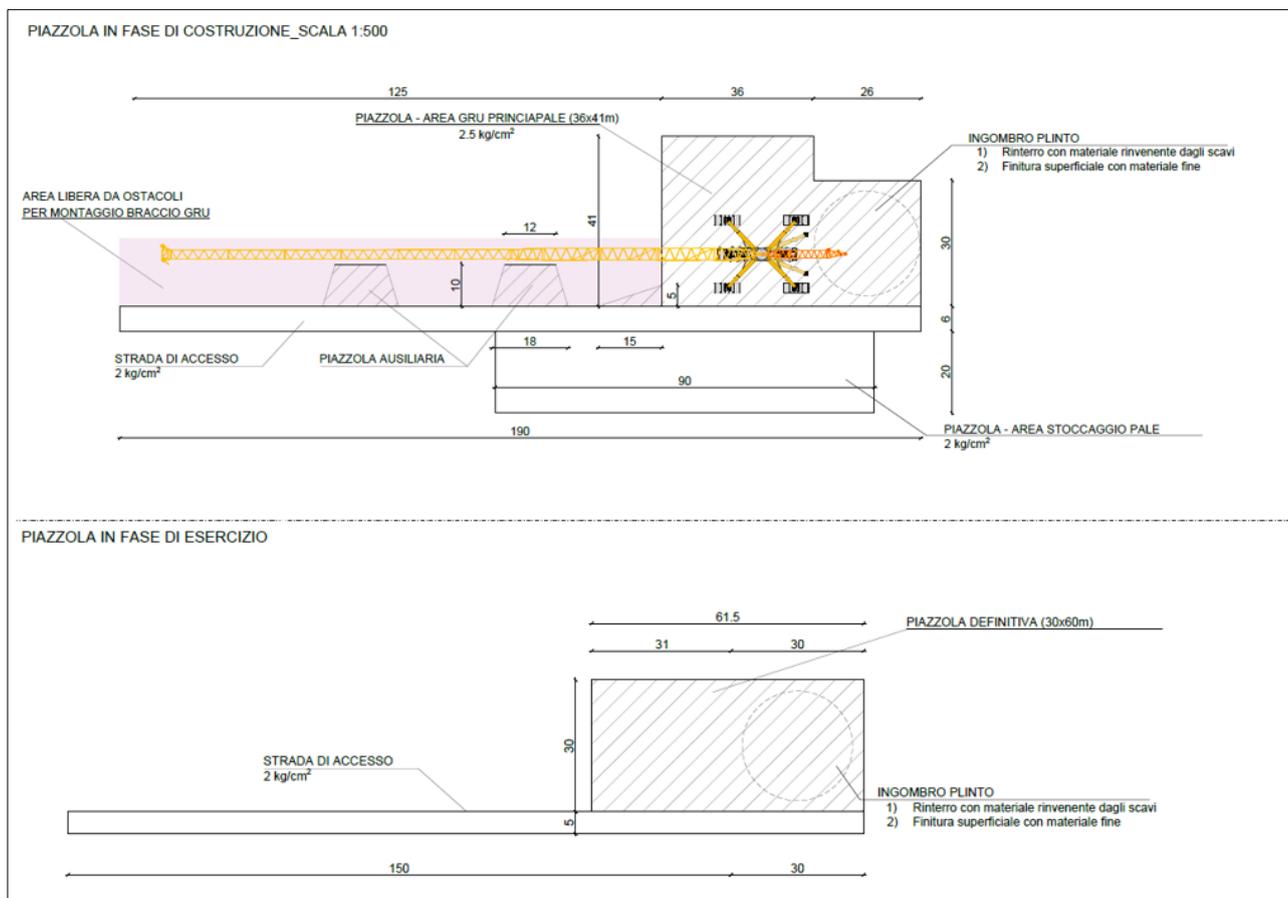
Planimetria piazzola tipo per la fase di installazione e fase di esercizio e manutenzione
